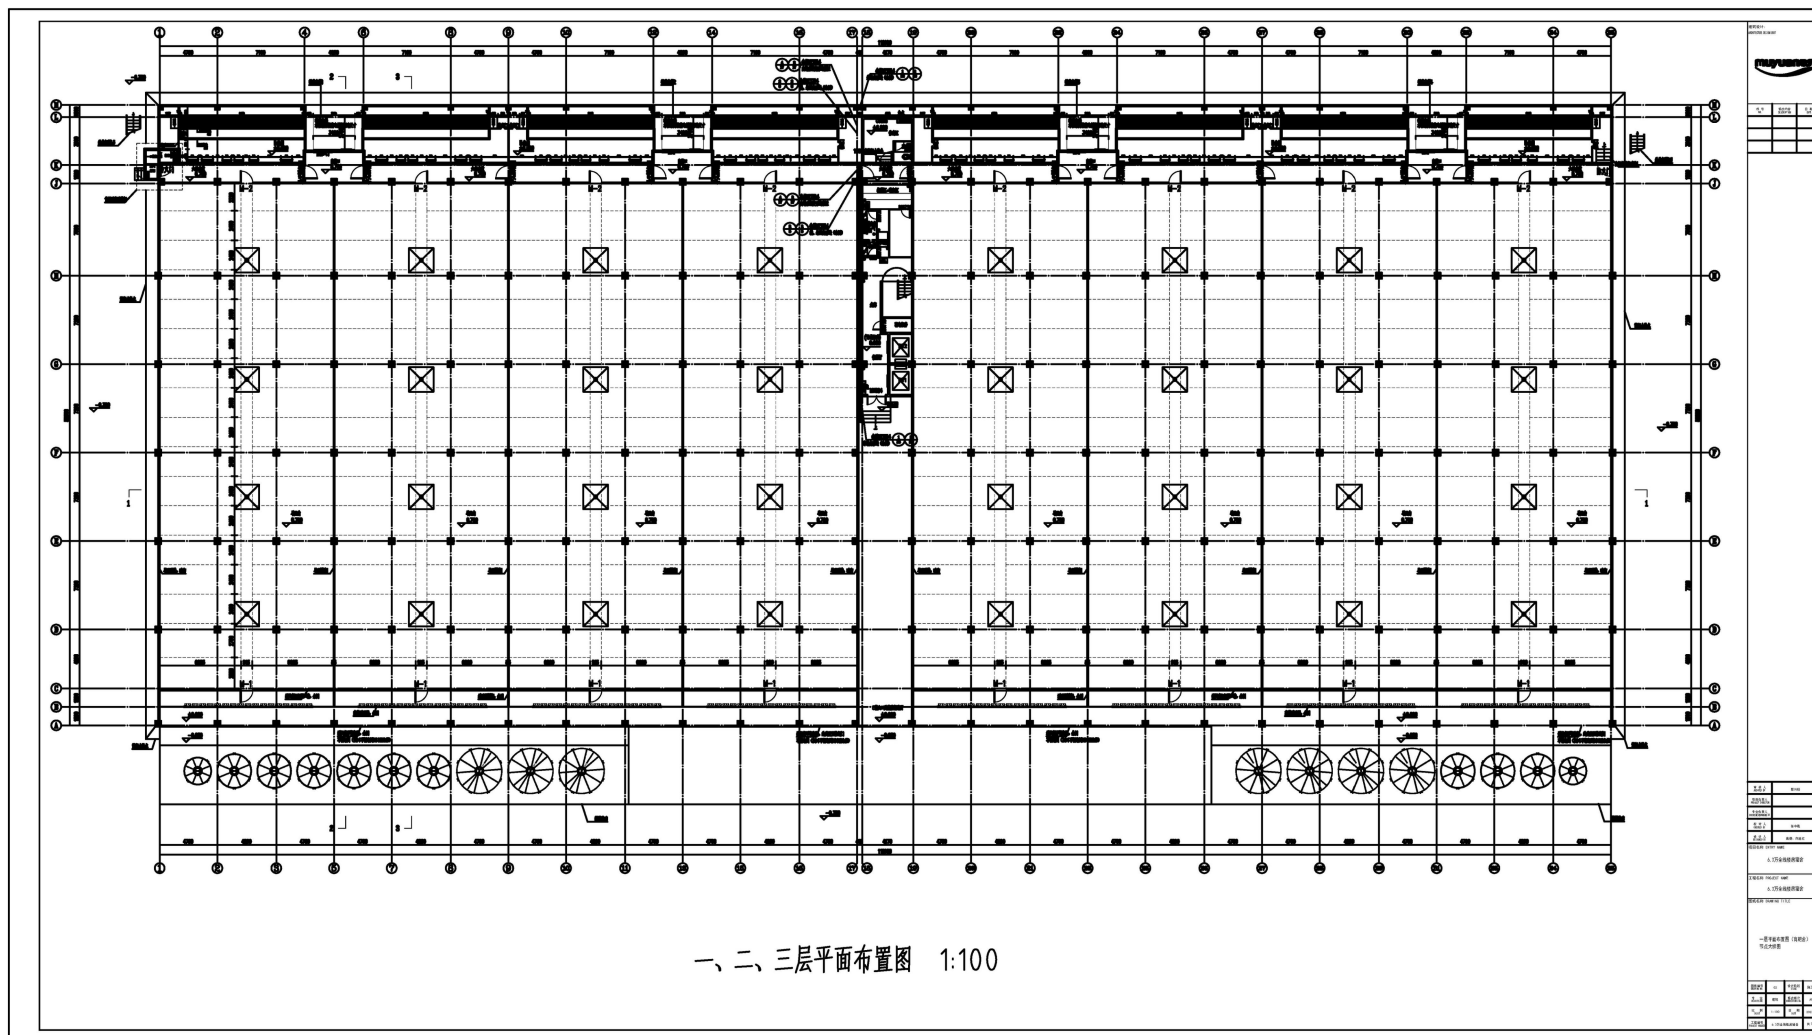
楼房猪舍（1-3层）平面布置示意图
